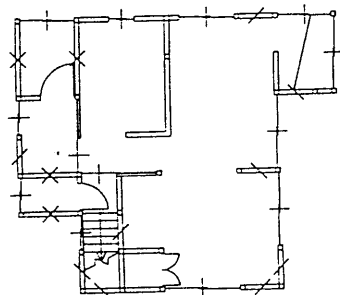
解析対象建築物平面図 (No.11, No.12)
